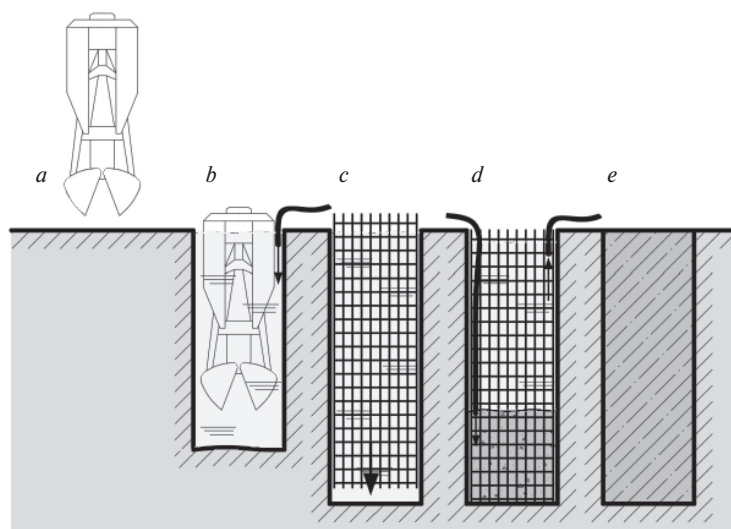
Технология «стена в грунте»: а – устройство траншеи; б – заполнение выемки бентонитом; с – опускание арматурного каркаса; д – замещение бентонита бетонным раствором; е – создание железобетонной несущей конструкции
